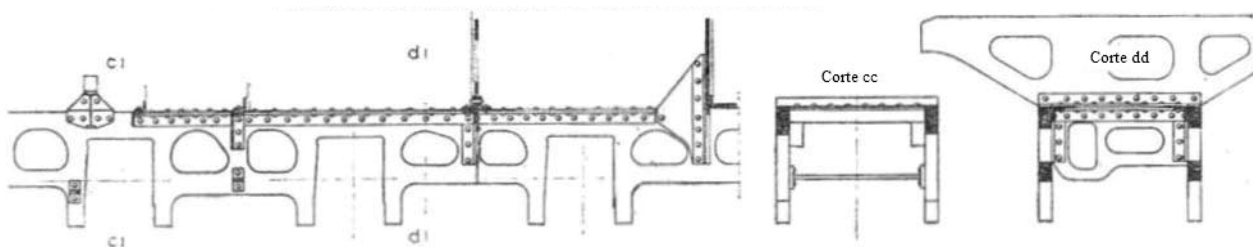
Largueros de barras, laminados, con planchas de refuerzo horizontales.
